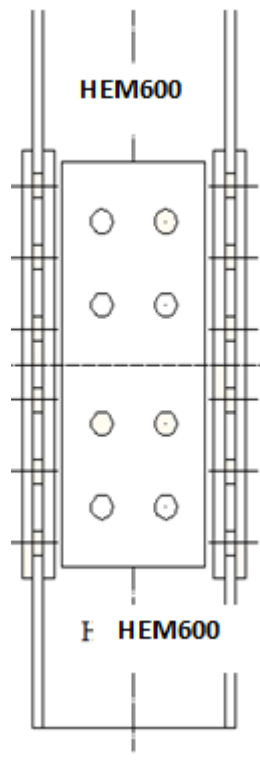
20: Assemblage poteau-poteau (HEM600-HEM600)
